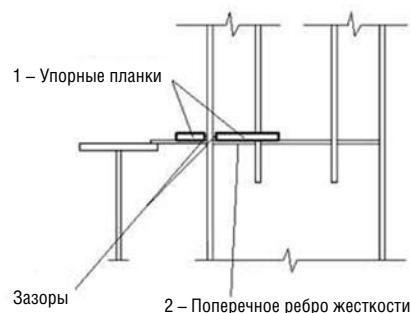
Разрушение сварного углового шва крепления поперечного ребра жесткости к поясному листу колонны
